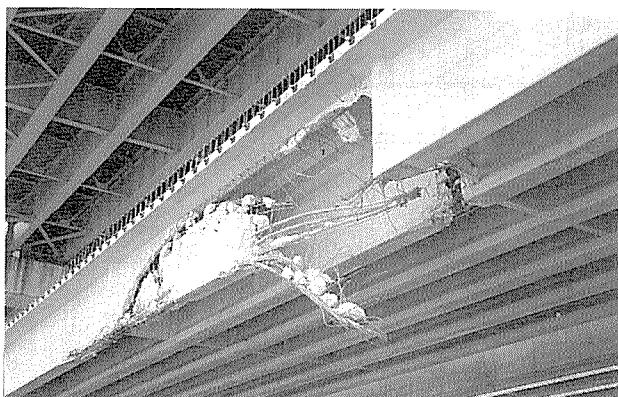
損傷状況 (P 101～P 102, 耳桁 (G 1))
